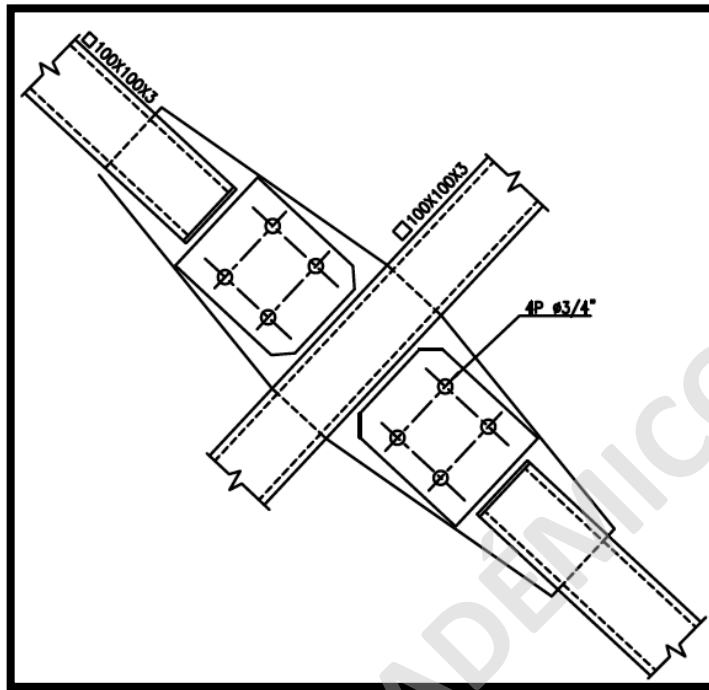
Detalle de Ver 1 y Ver 2 ODR Ingeniería y Montaje.
